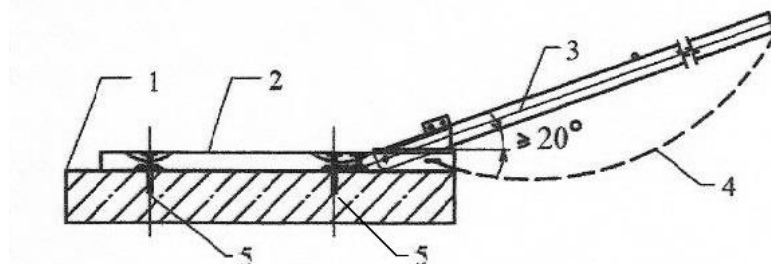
Схема установки Защитно-улавливающей сетки (ЗУС) по монолитному перекрытию зданий и сооружений.
